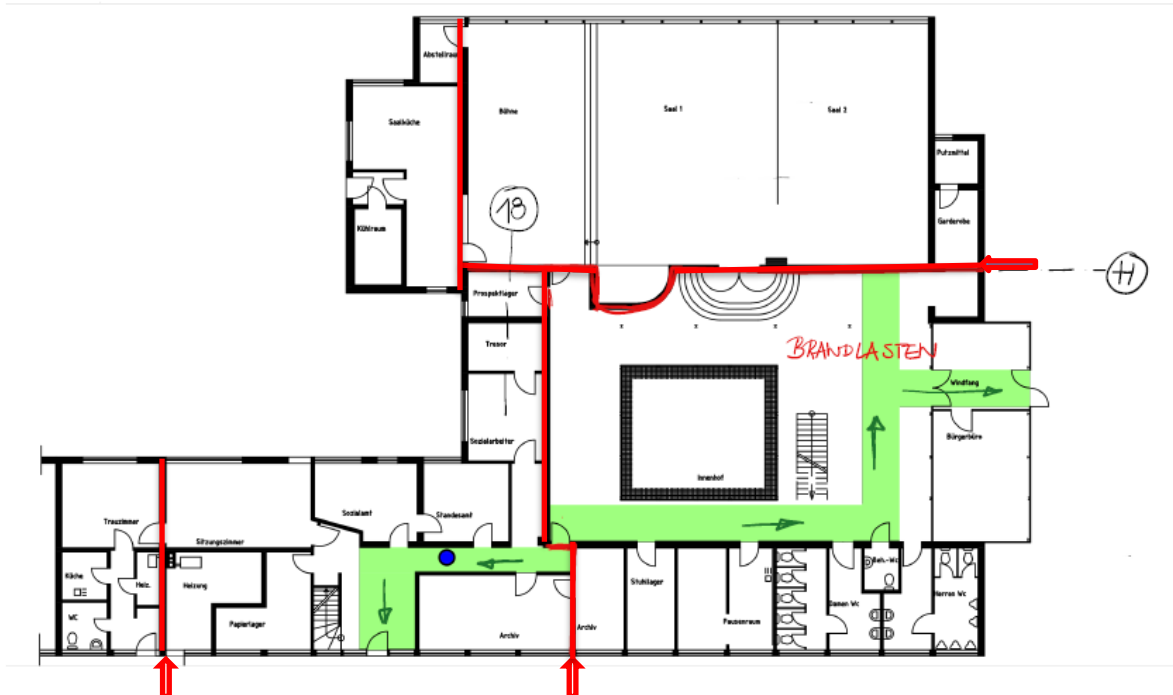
Grundriss EG, aus Flucht- und Rettungswegeplan
